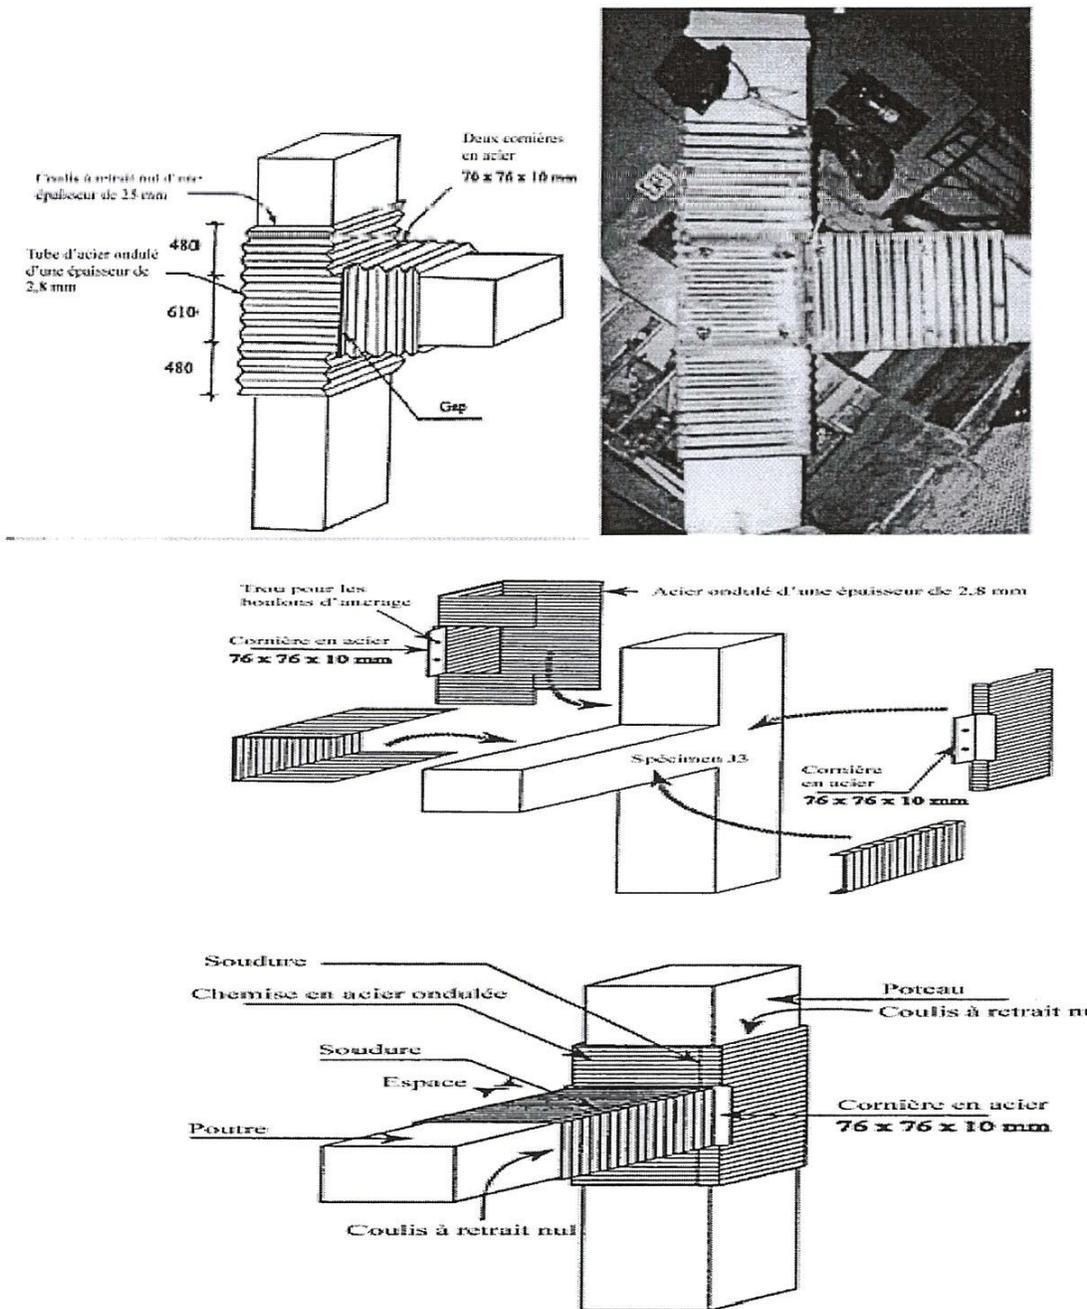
Assemblage de chemises de poutre et de poteau [13].
